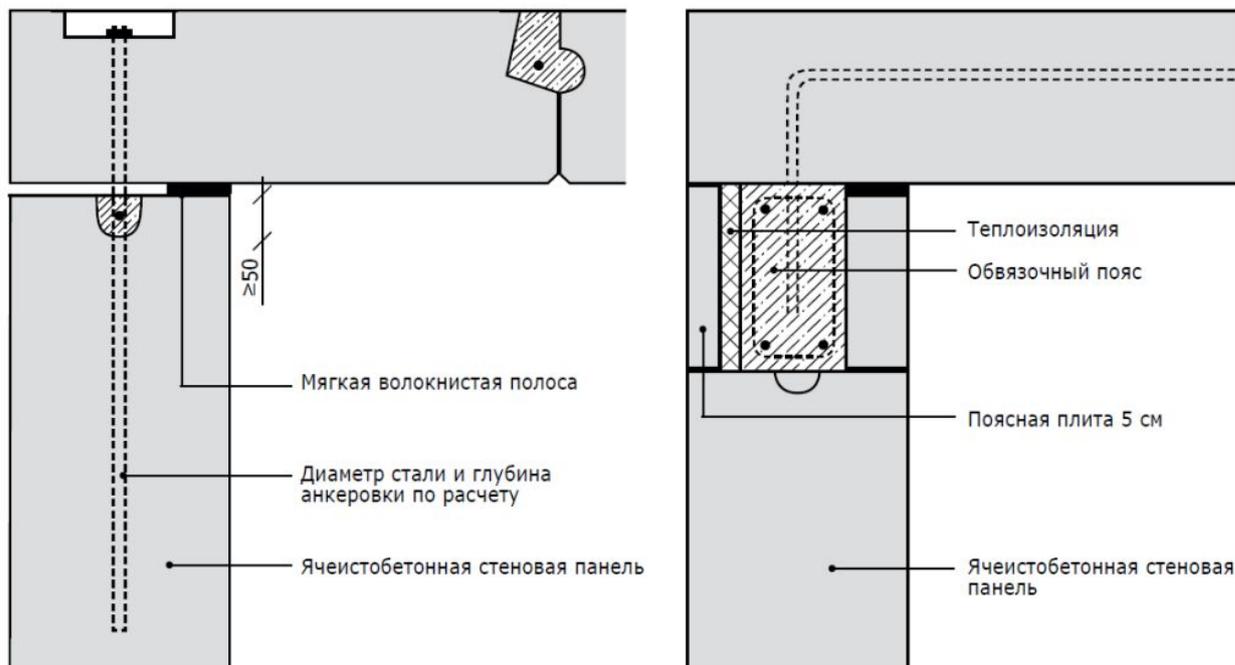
Зона сопряжения стена-покрытие. Одностороннее опирание панелей покрытия на стеновые панели
